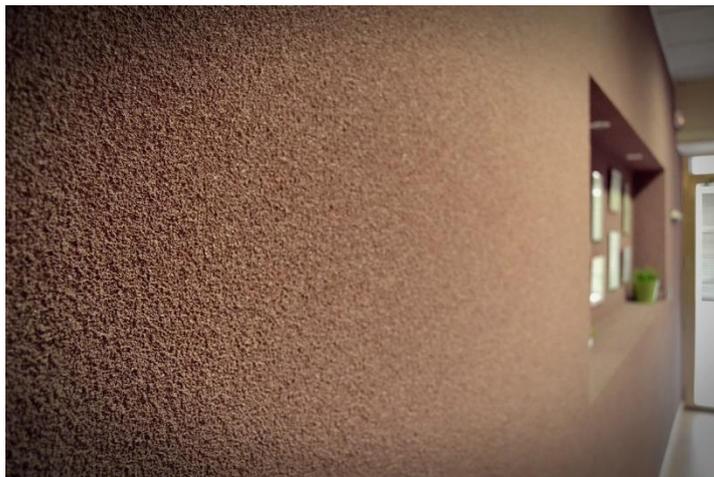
Aplicación de corcho proyectado en paramentos exteriores. Fuente: edifitecta.es
